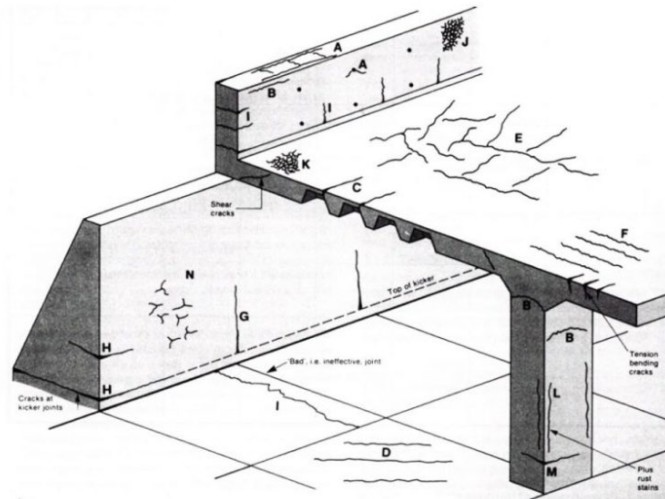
Tipos de fisuras en concreto reforzado, Tomado de: : <https://cemsolutions.org/types-of-cracks-in-concrete/>
